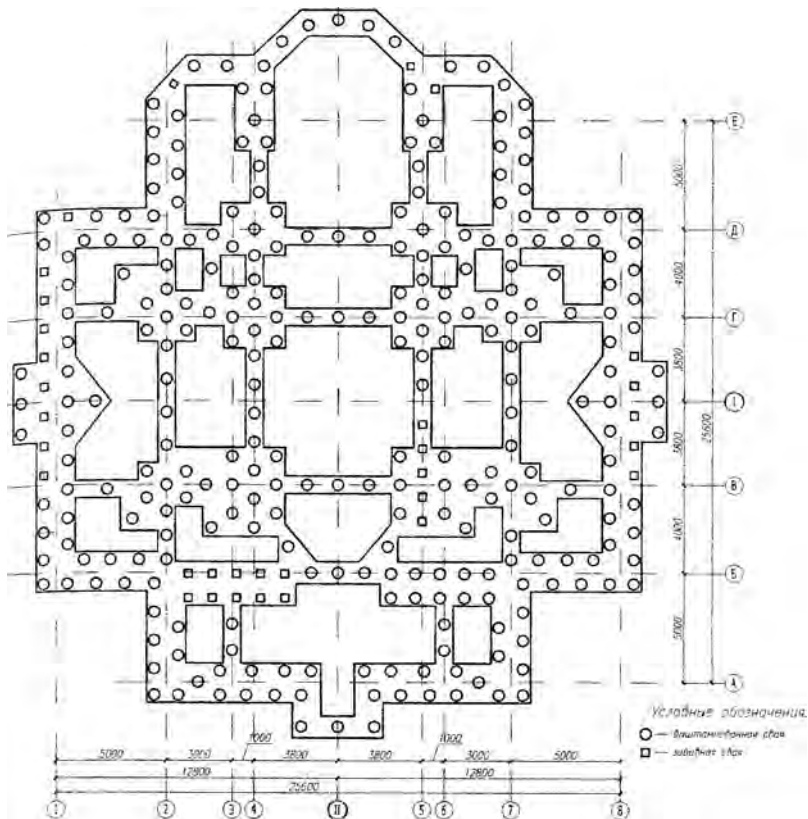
Свайно-плитный фундамент под храм во имя Архистратига Божия Михаила в м-не Сухарево в г. Минске
